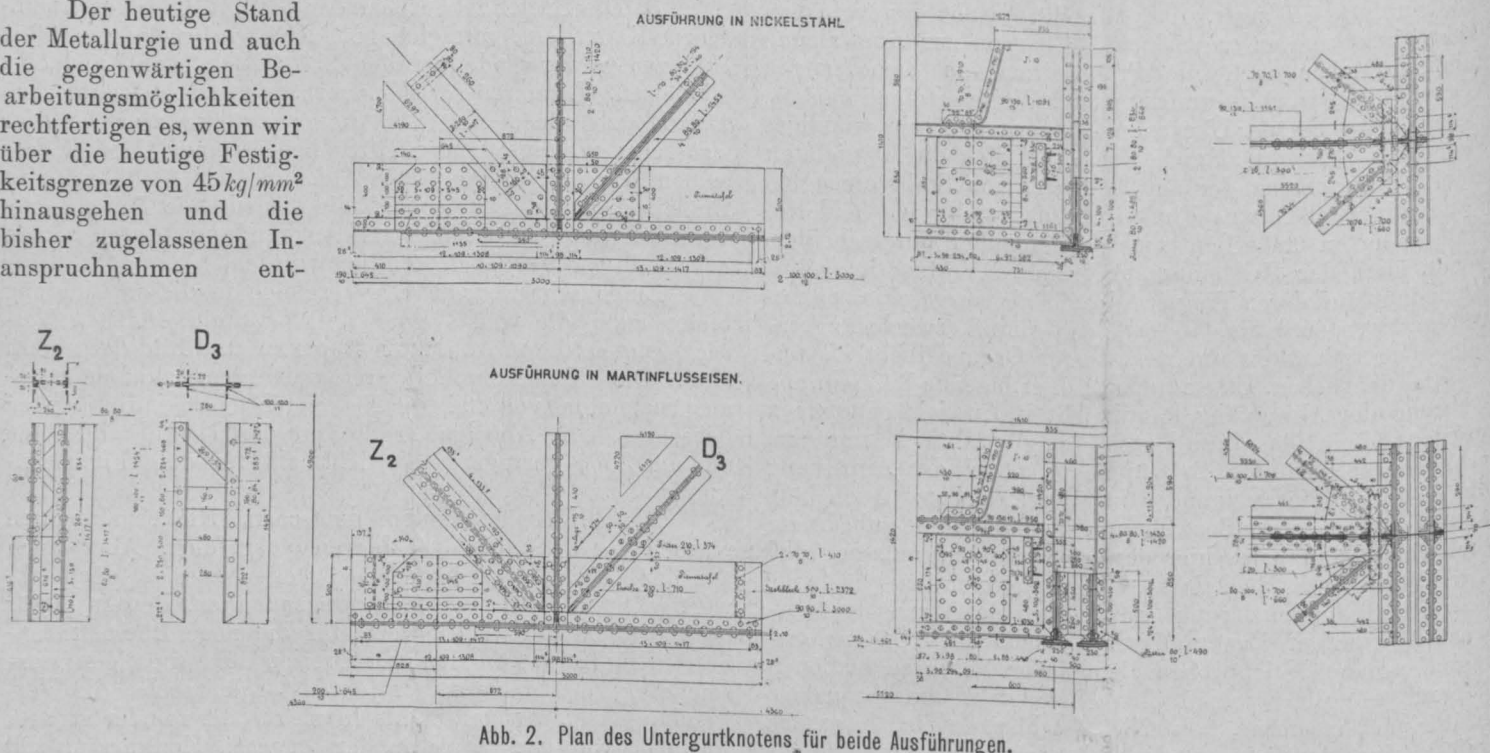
Plan des Untergurtnotens für beide Ausführungen.
